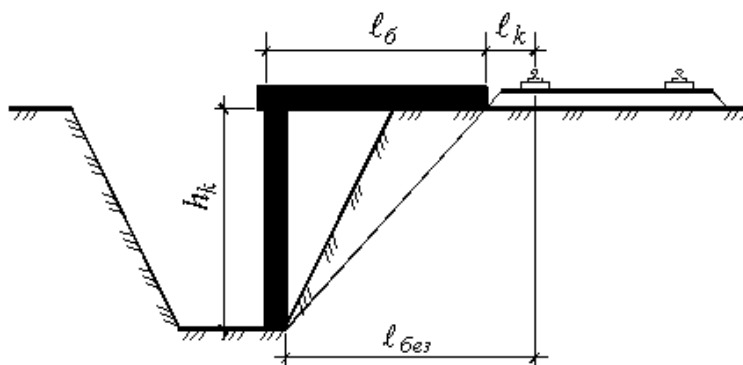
Схема поперечной привязки подкрановых путей при возведении подземной части здания
